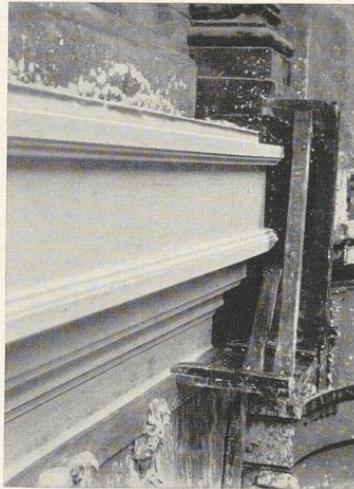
Wandzug ohne Läuferführung mit Kopfschablone
